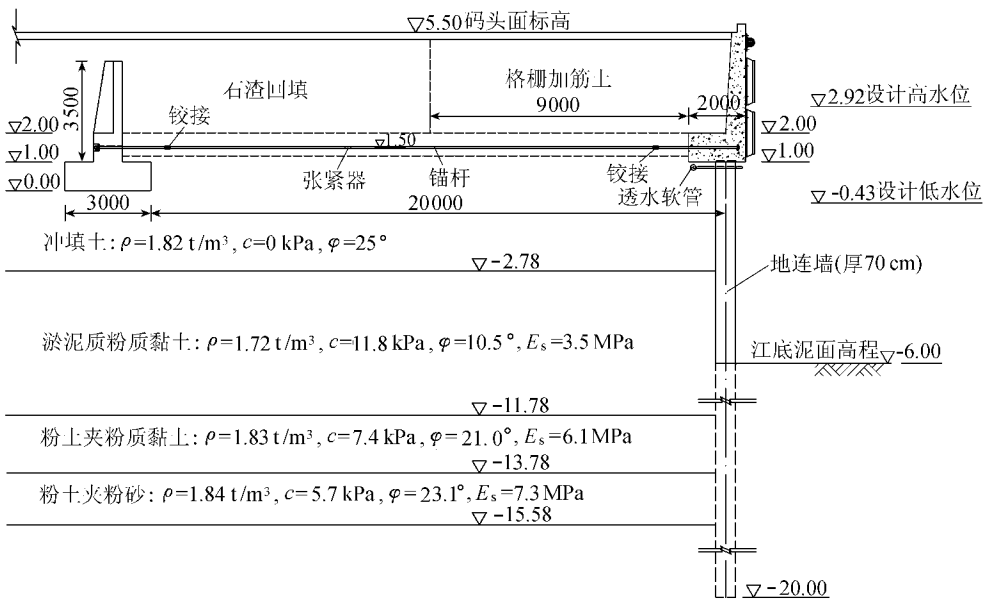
码头结构断面及各土层物理力学指标(高程单位:m;尺寸单位:mm)
